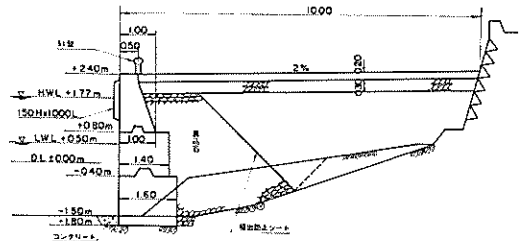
塩釜港代ヶ崎物揚場 (-1.5m) 標準断面図
